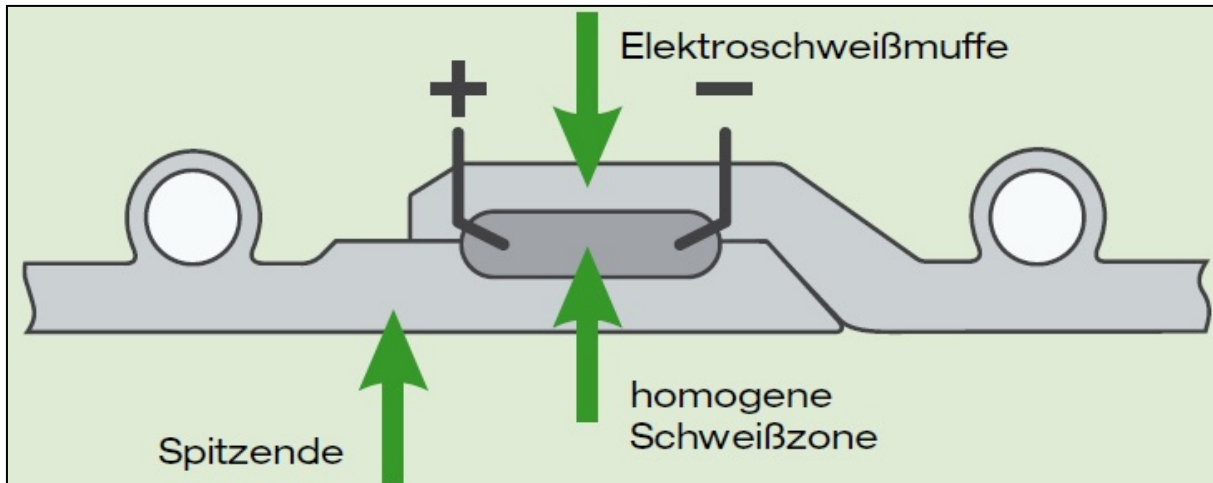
Prinzipieller Aufbau Elektroschweißmuffen - Verbindung beim PKS-Rohr
